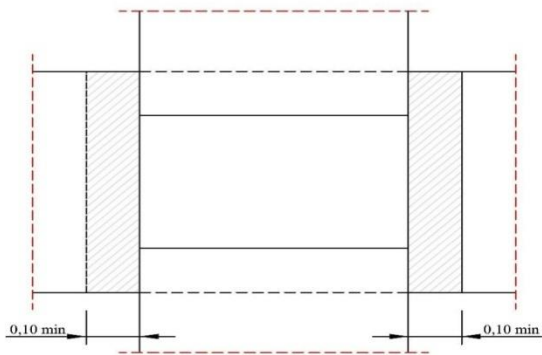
Soudure à plat du 2ème joint linéaire en attente
